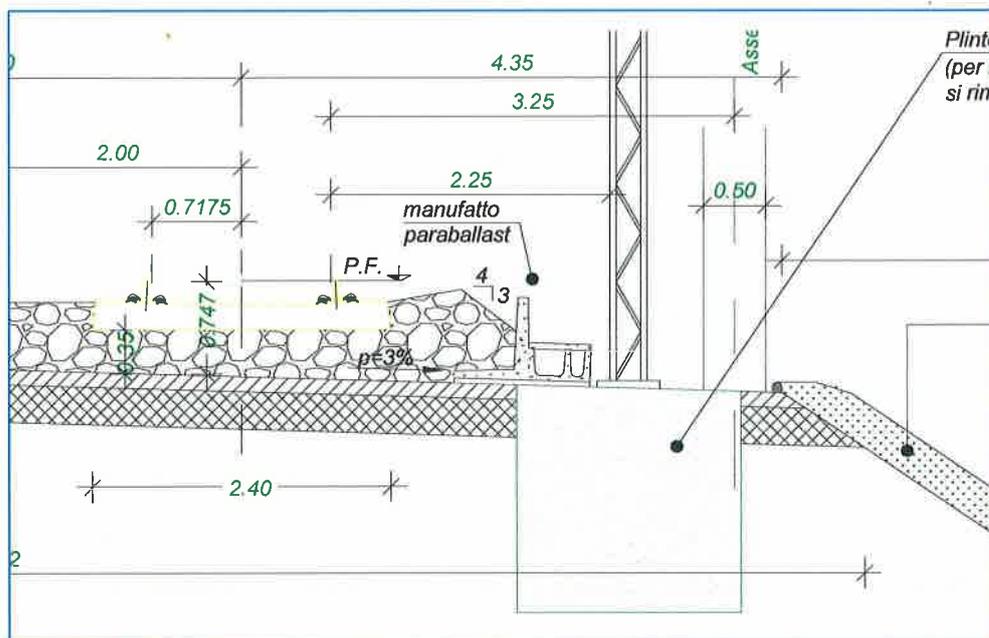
Sezione in rilevato-particolare drenaggio al ciglio: canaletta porta-cavi, cordolo, embrici
